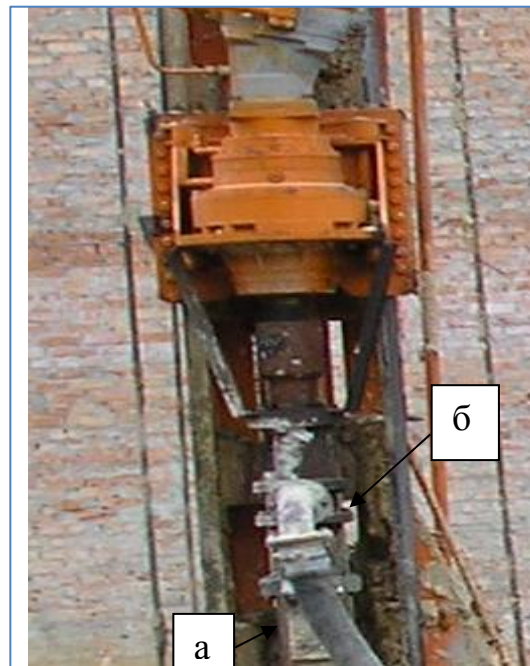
Вертлюг: а – рухома частина; б – нерухому частина
